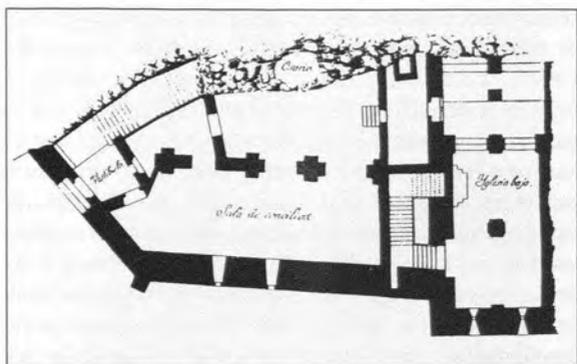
San Juan de la Peña. Planta de la zona baja del monasterio, según R. Magdalena.
